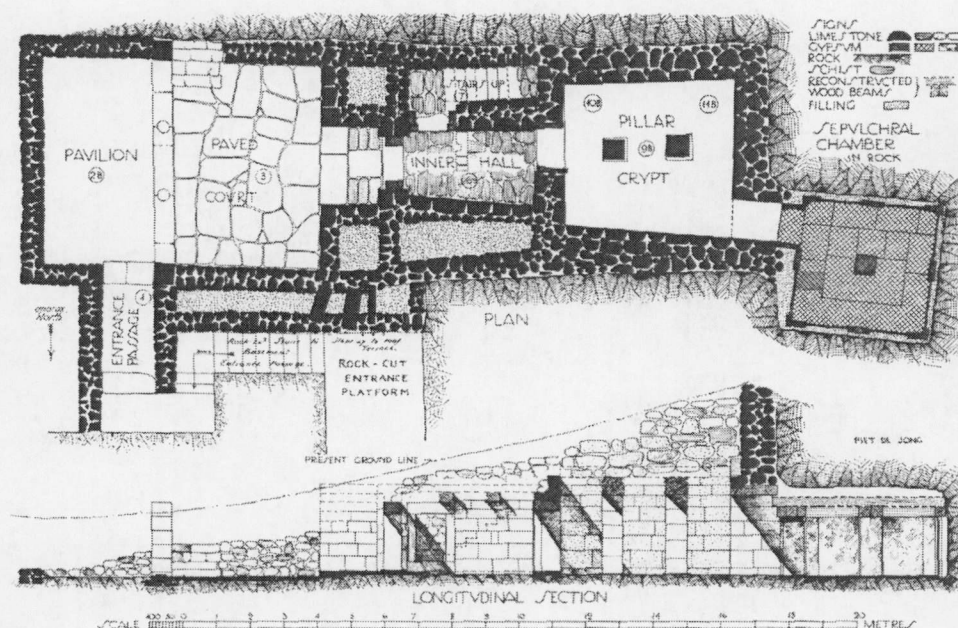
Plan du *Temple Tomb* de Knossos, d'après *PofM* IV, plan pochette.
